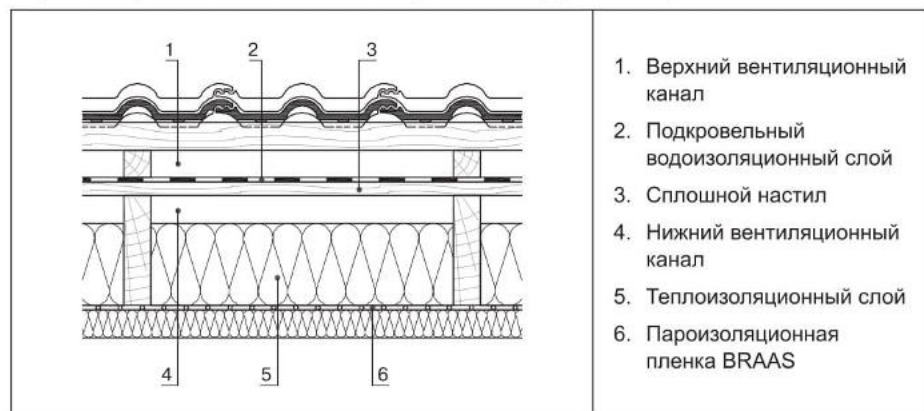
Кровля со сплошным настилом, с утеплением, с двумя вентиляционными каналами
